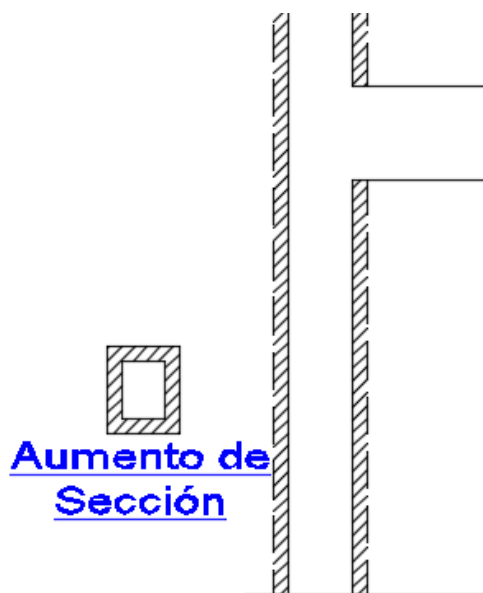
Encamisado de columna C-1 columna CR1 y vigas peraltados
